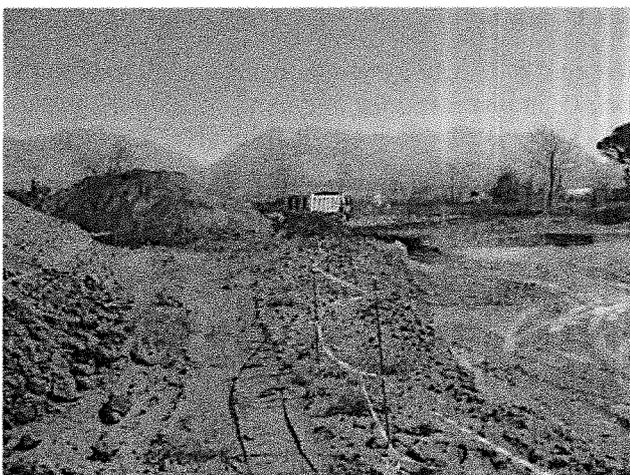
Ulteriore dettaglio dell'Area scavo 2 - Area Ovest
